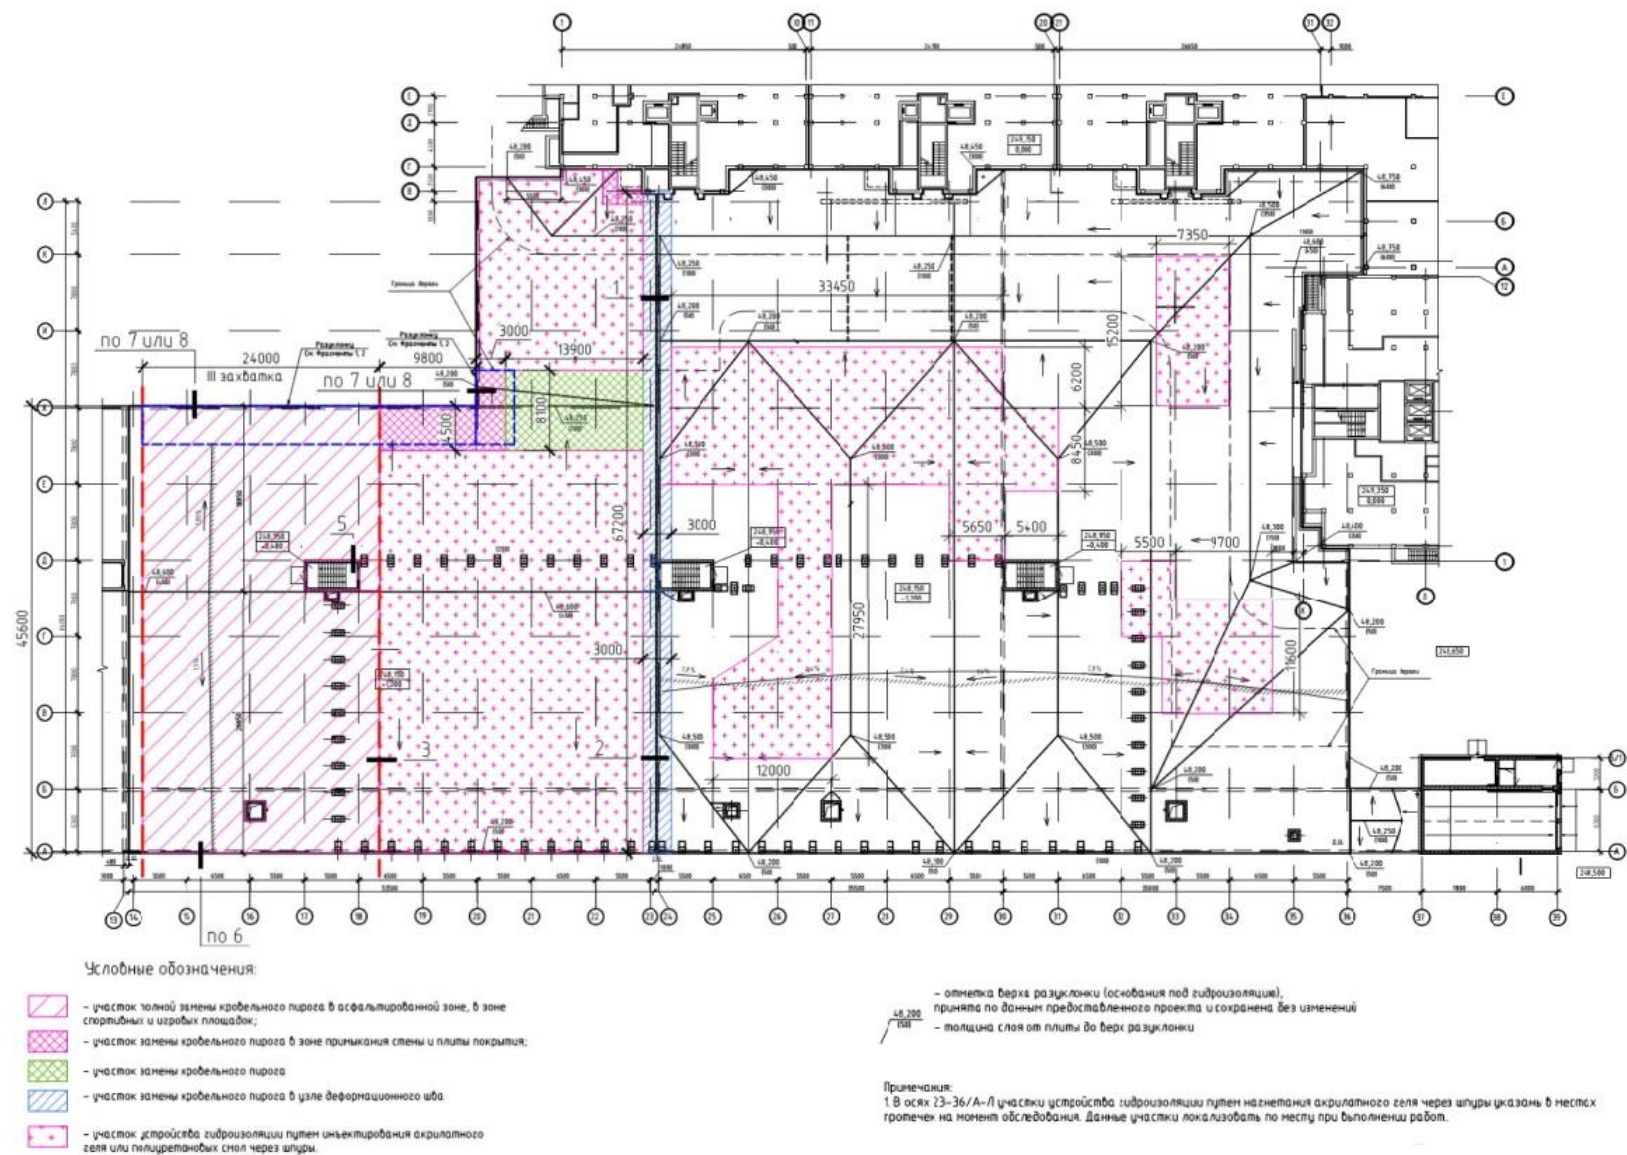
Вариант №1. Схема участков замены кровли.
